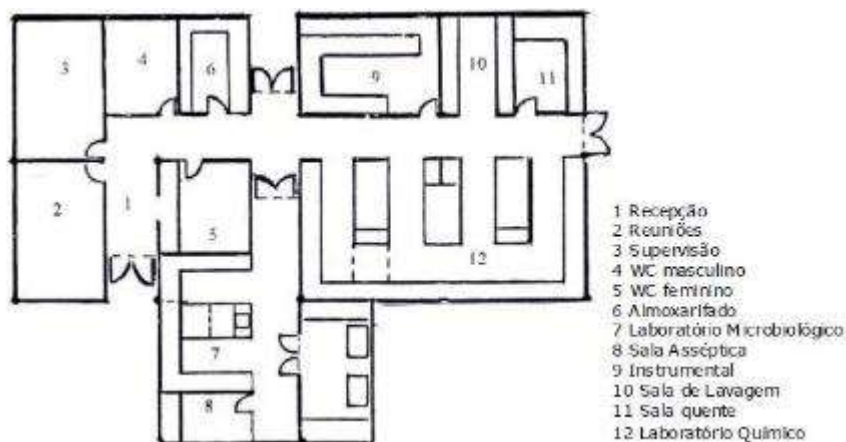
Planta de um laboratório químico e outras instalações. 3.2 Projeto elétrico/Iluminação
